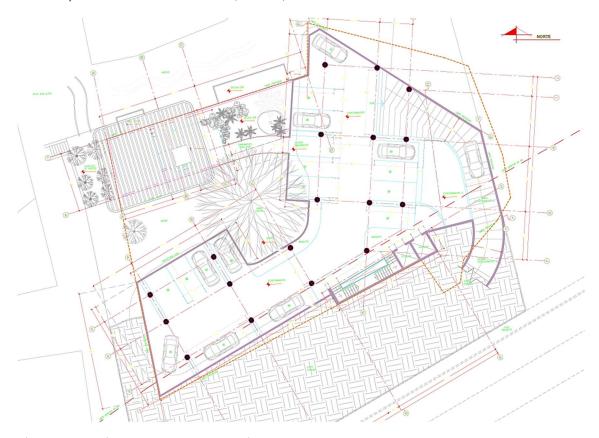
Planta arquitectónica estacionamiento 1 (sótano 1)
